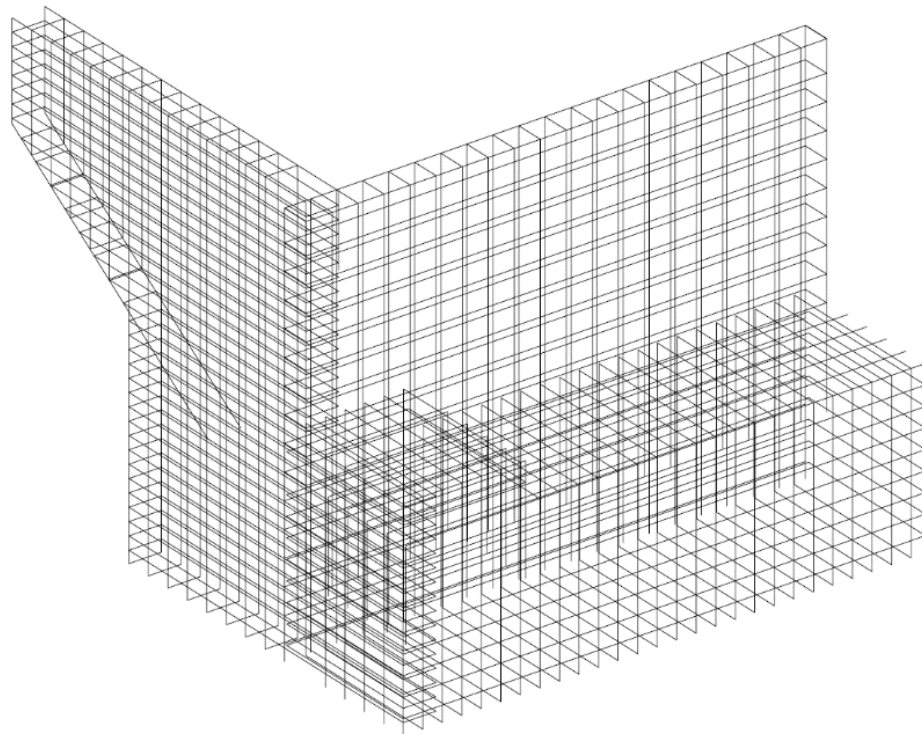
Vista General de Refuerzos de Mitad de Estribo Puente Águila Norte.
